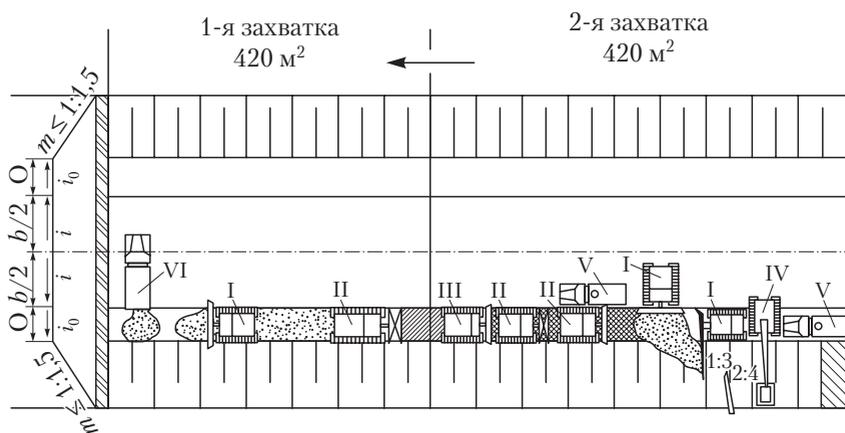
Схема производства работ по укреплению откоса грунтом, обработанным цементом:
